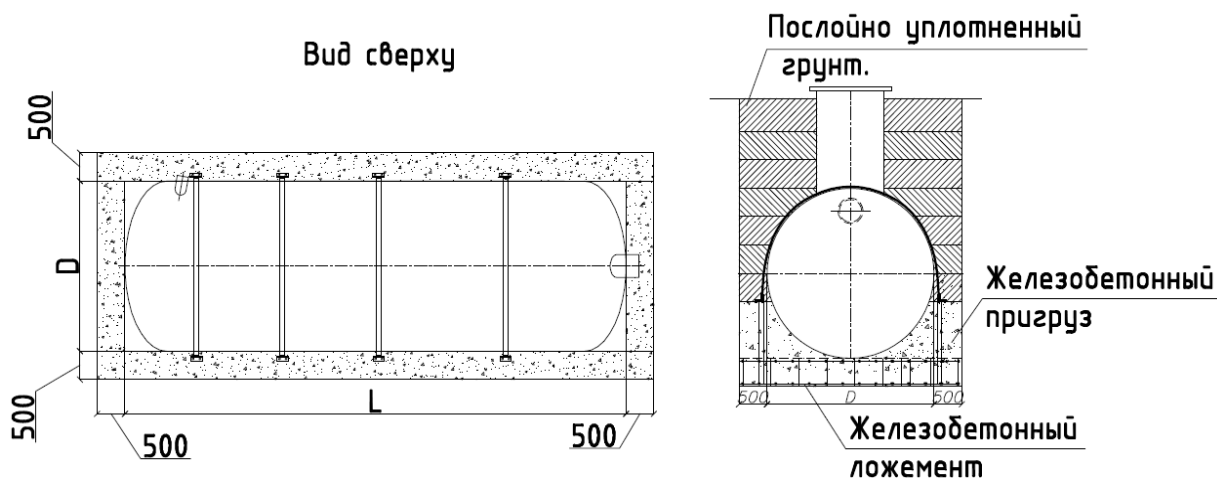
Пример монтажа оборудования при высоком уровне грунтовых вод
